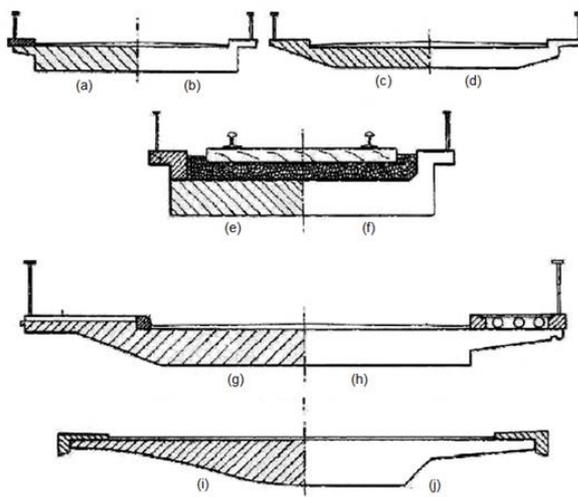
Différentes sections en dalle pleine pour un pont dalle
